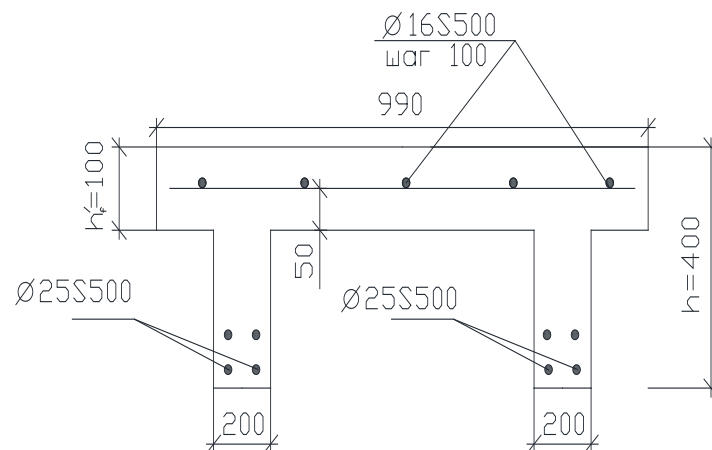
Схема армирования ребра и плиты блока перекрытия тоннеля
